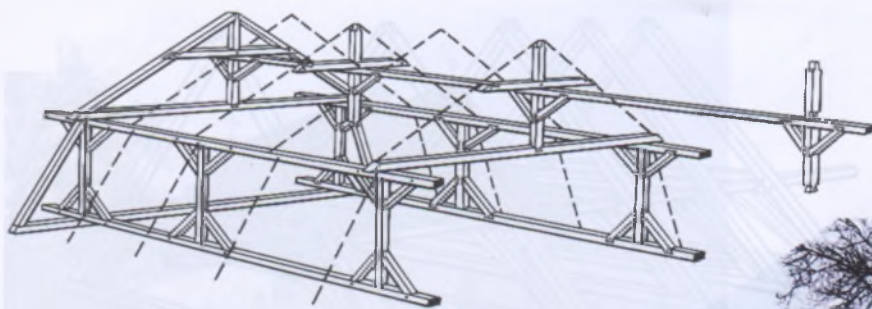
Конструкция мансардной крыши со стропильно-ригельными фермами с тремя подстропильными рамами. Плебания в Несвиже, XVIII в.
